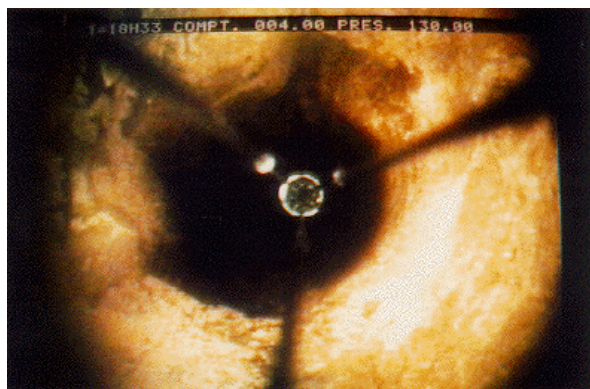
(4.0 m)-Zona fisurada por encima del nivel piezométrico.
